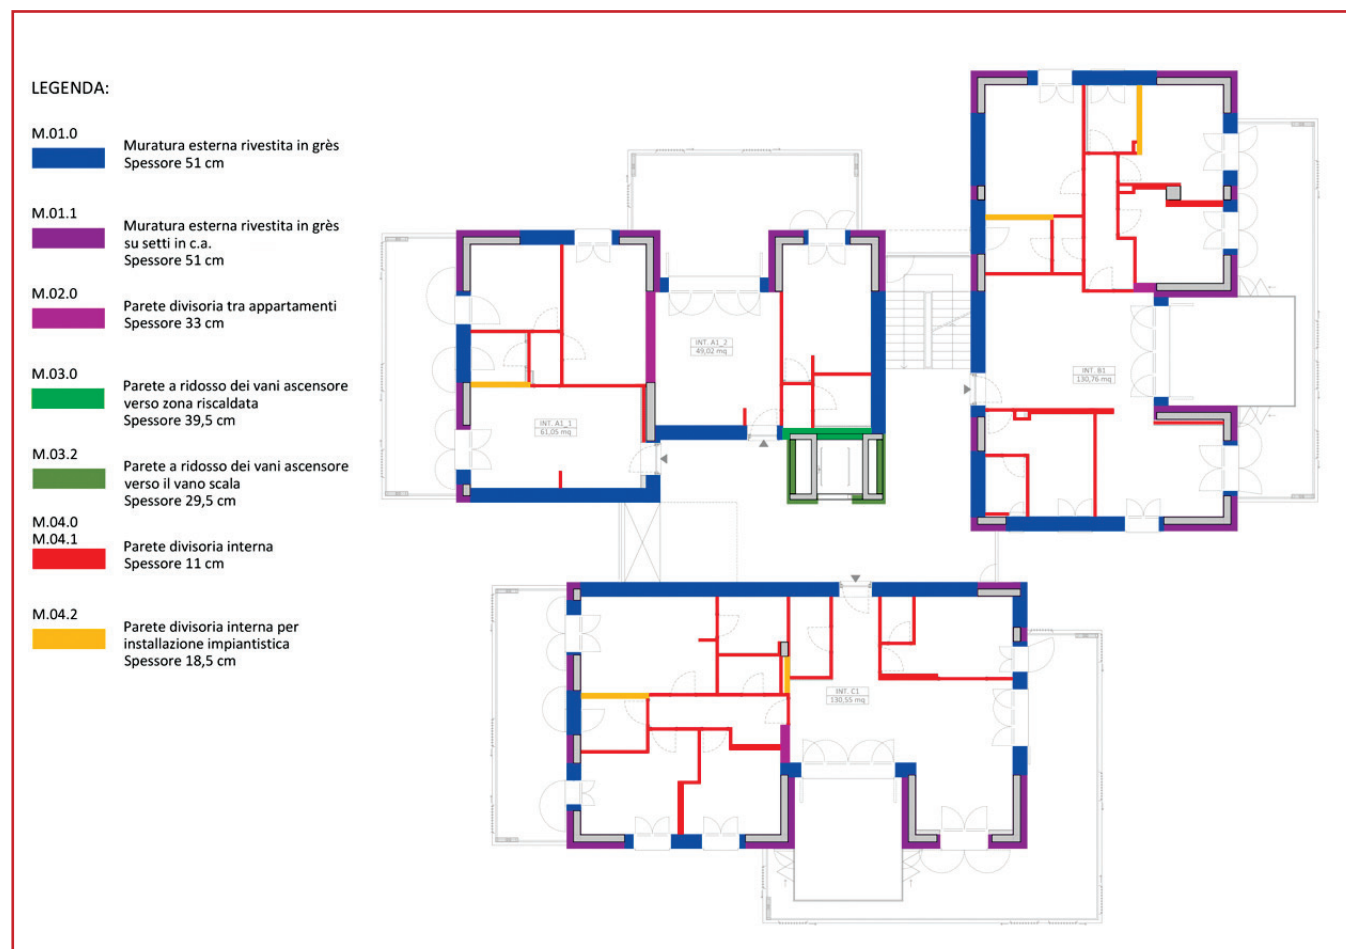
Tipologia delle murature impiegate sul piano tipo.
